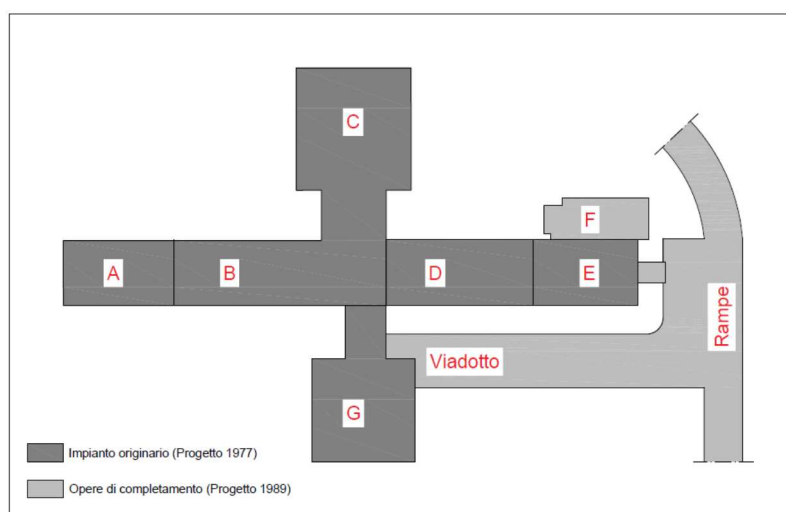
Schema dell'impianto originario e delle opere di completamento
